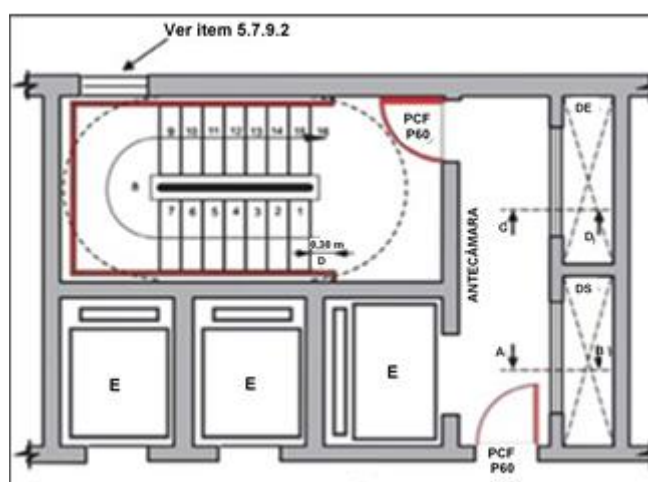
e Figura 17 – Escada Enclausurada à Prova de Fumaça com elevador de Emergência (a posição deste é somente exemplificativa) na antecâmara (demonstração dos dutos).
